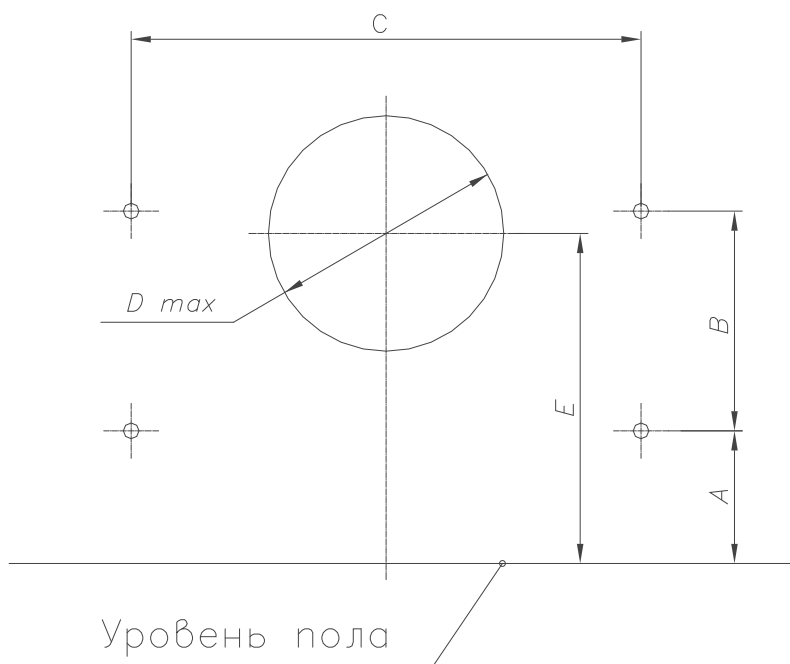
Схема расположения отверстий под крепления аппарата (котла)
